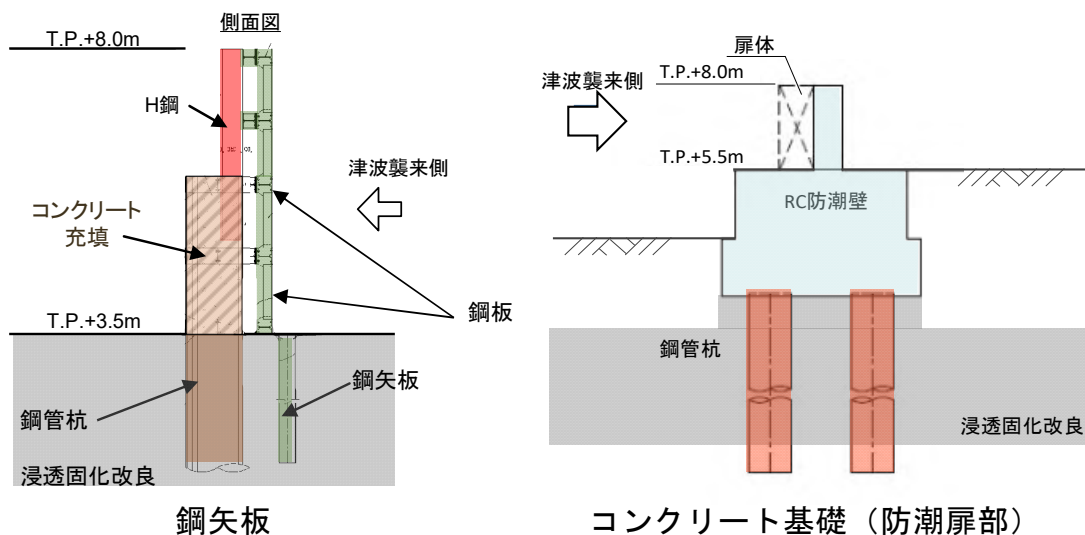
放水口側防潮堤および防潮扉詳細断面図
